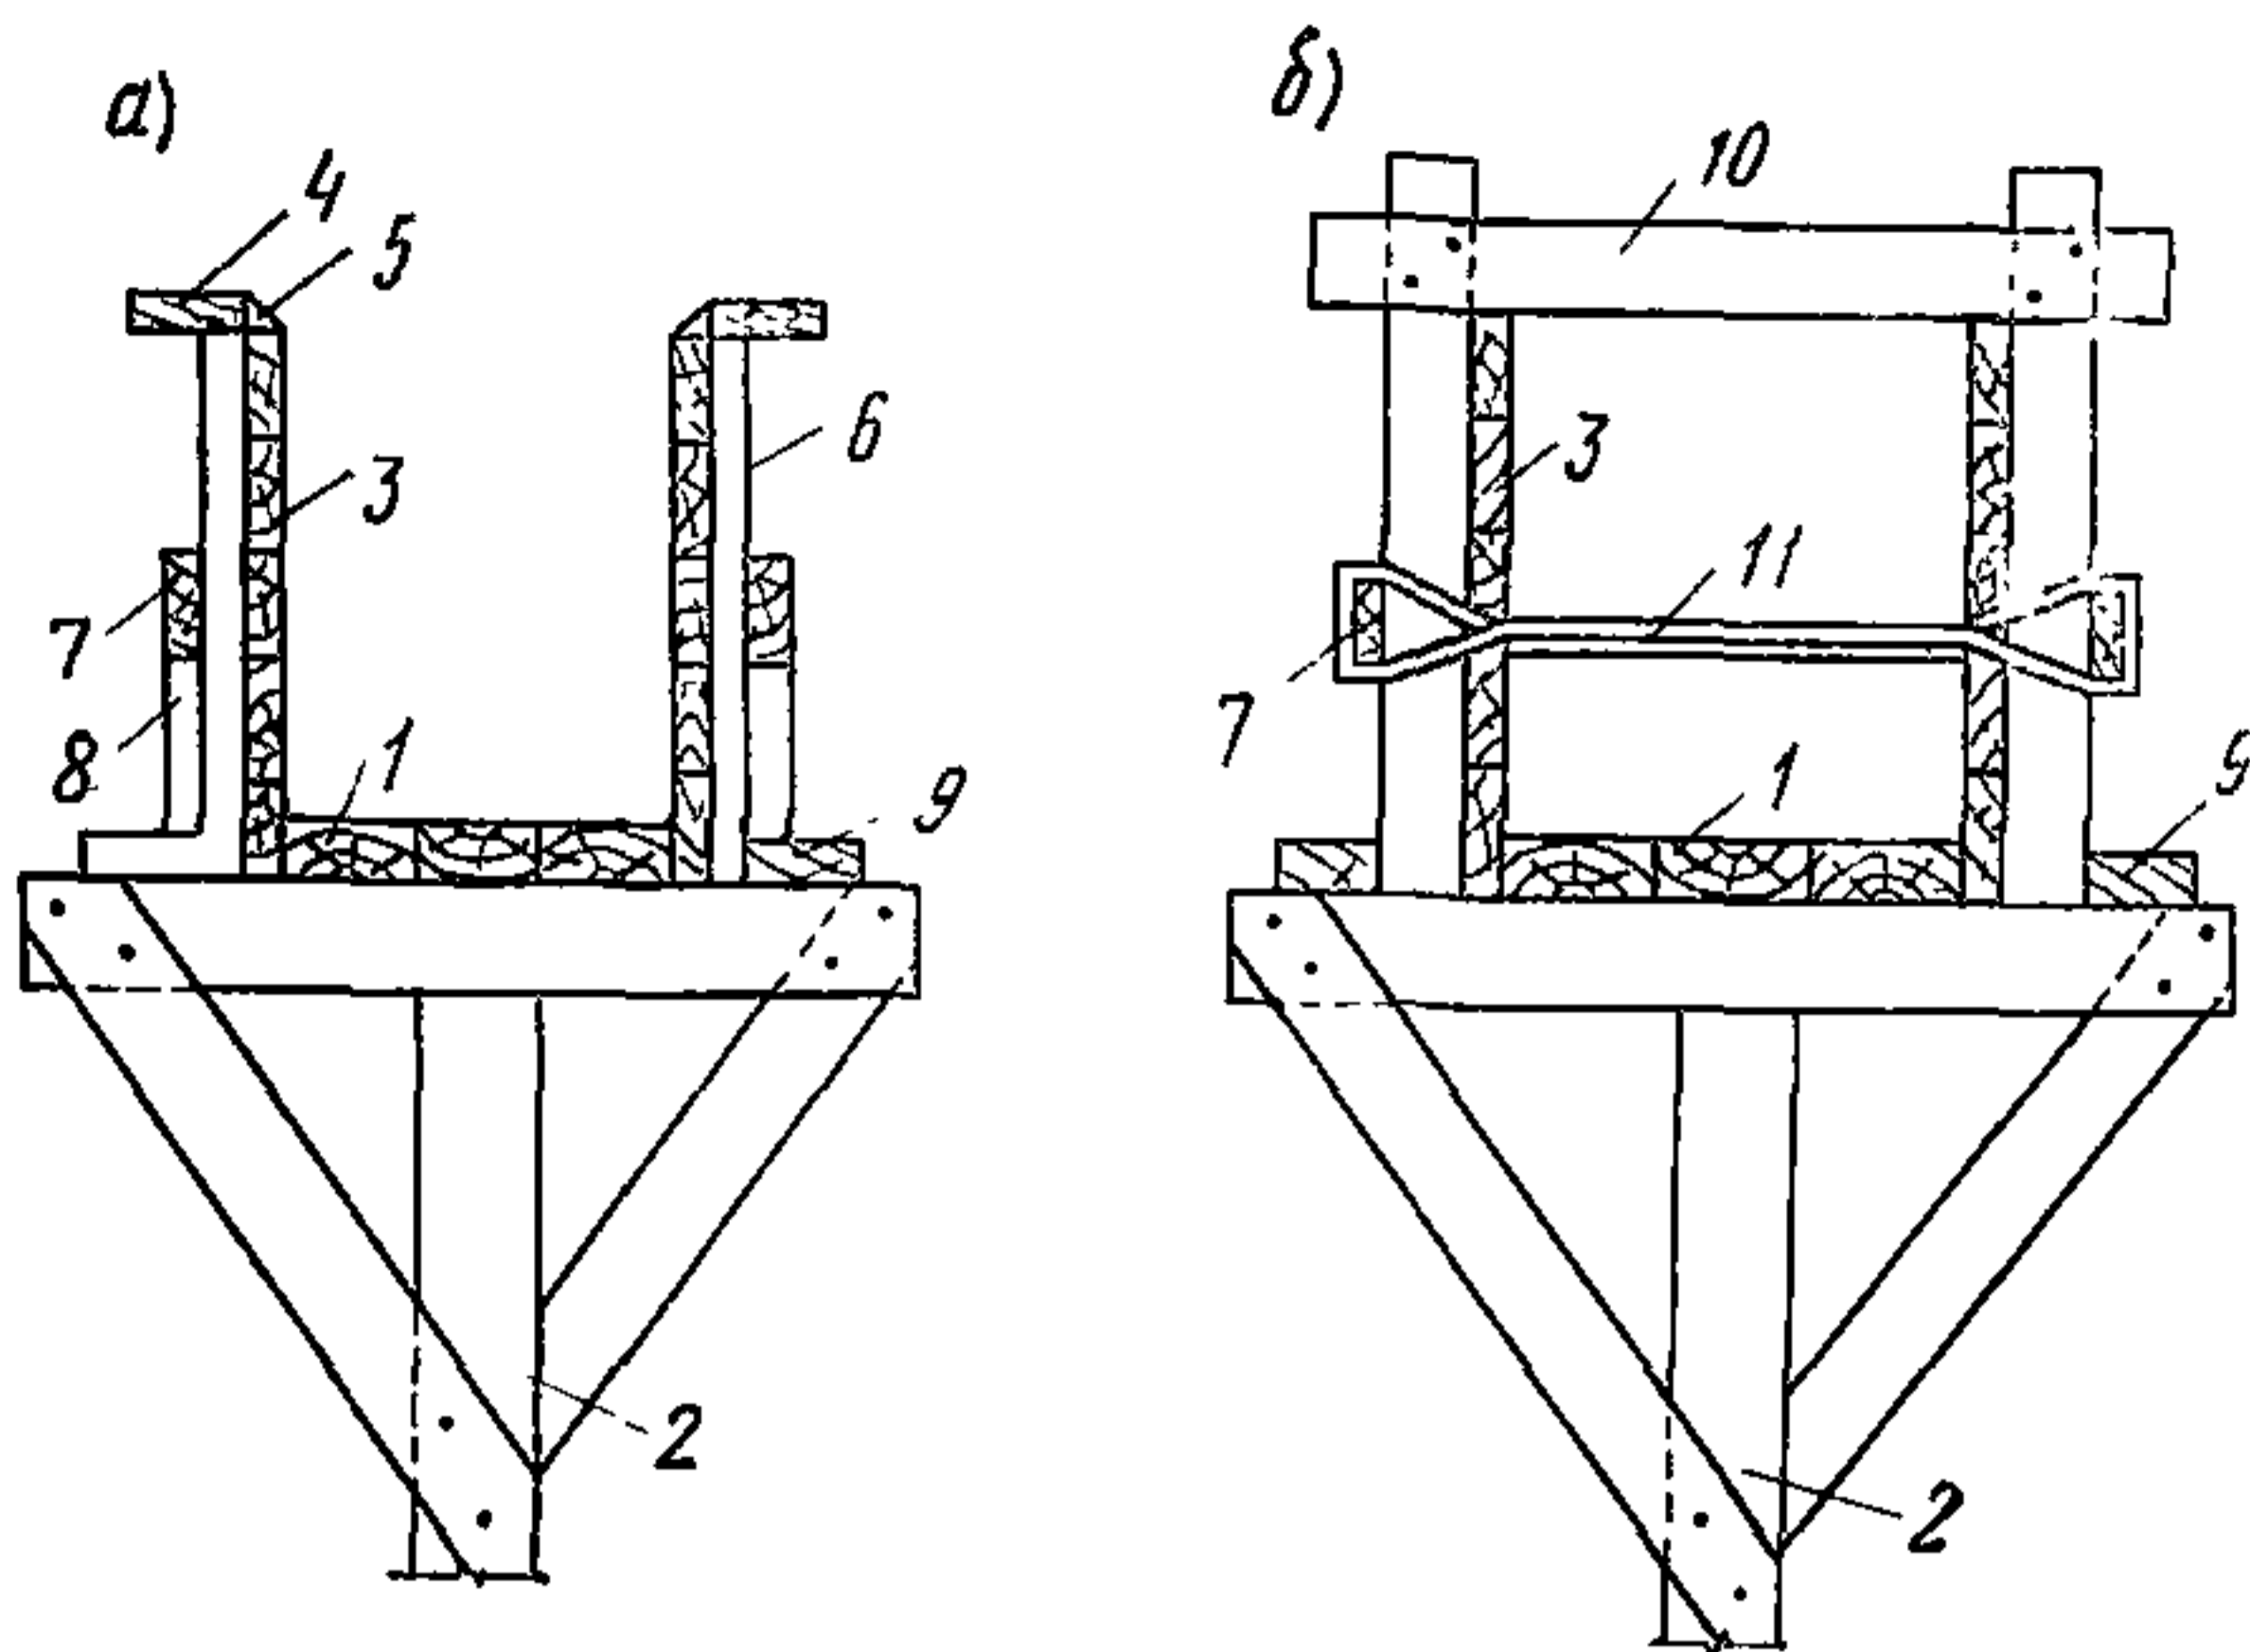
Схема опалубки железобетонных ригелей и балок из деревянных щитов
